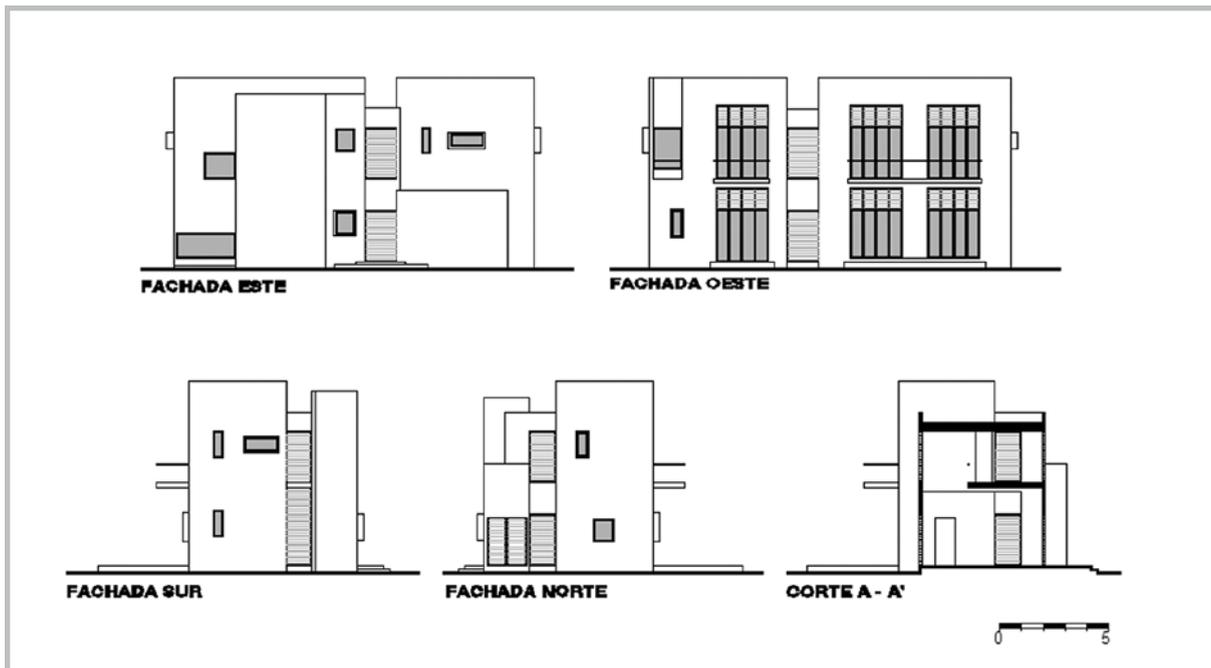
Fachadas y corte “El Hormiguero”. Fuente: Planos María Clara Betancourt (2010)
